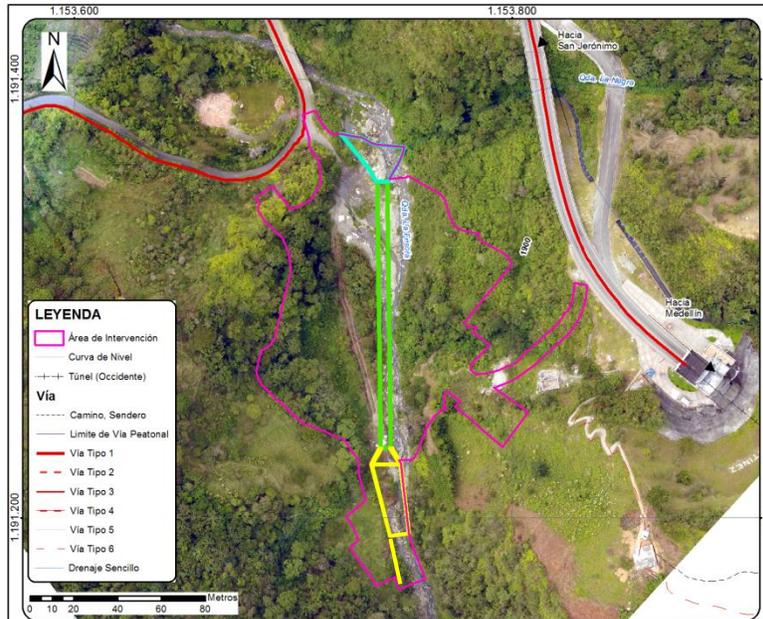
Ubicación esquemática del box culvert sobre la quebrada La Frisla
